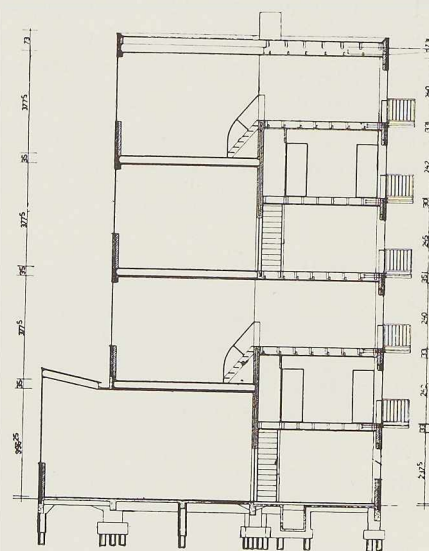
Coupe verticale dans la façade nord du bâtiment.
